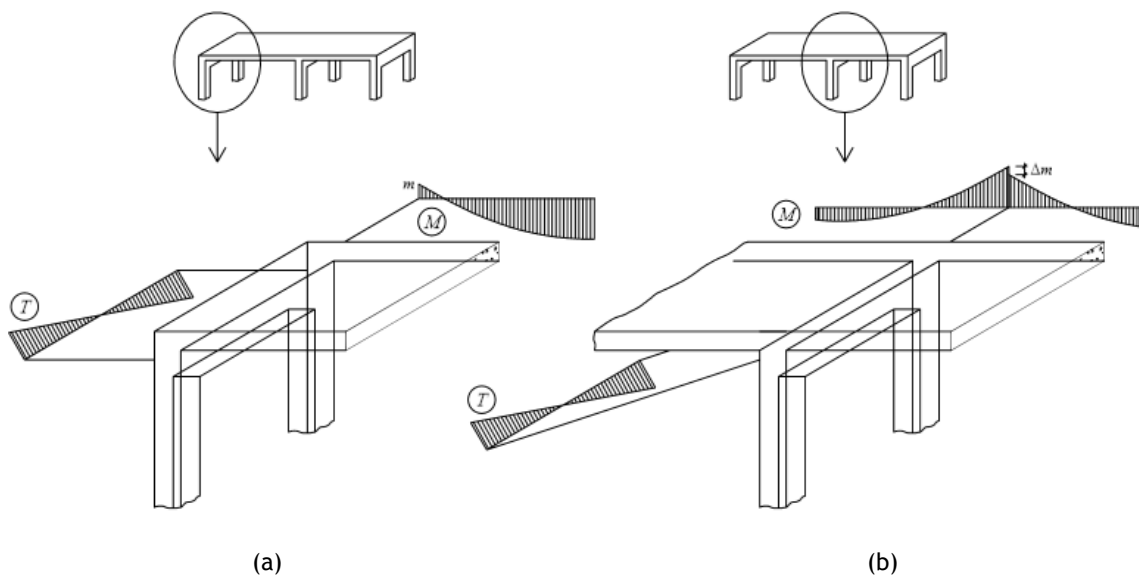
Laje de pavimento com apoios de extremidade (a) e de continuidade (b) [9]
